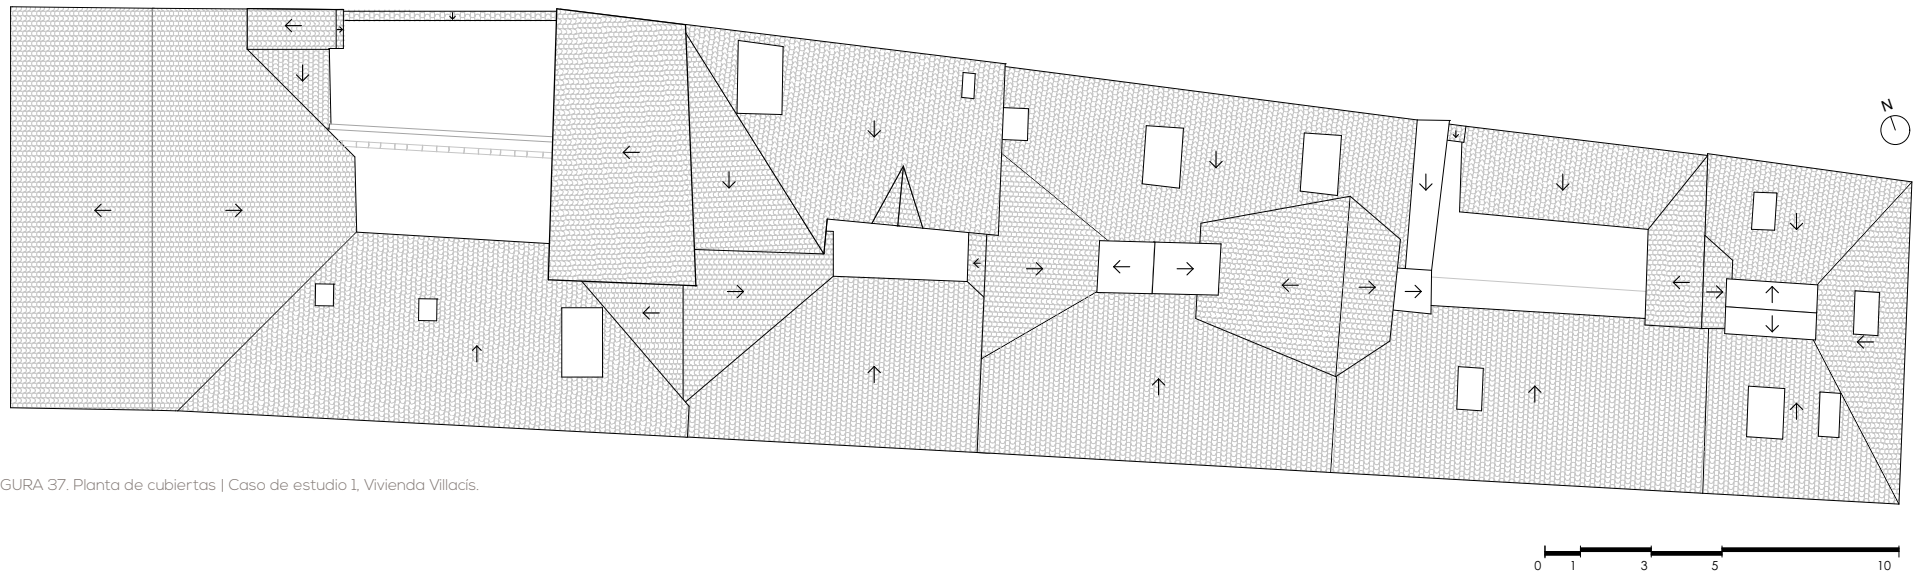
Planta de cubiertas | Caso de estudio 1, Vivienda Villacis.
